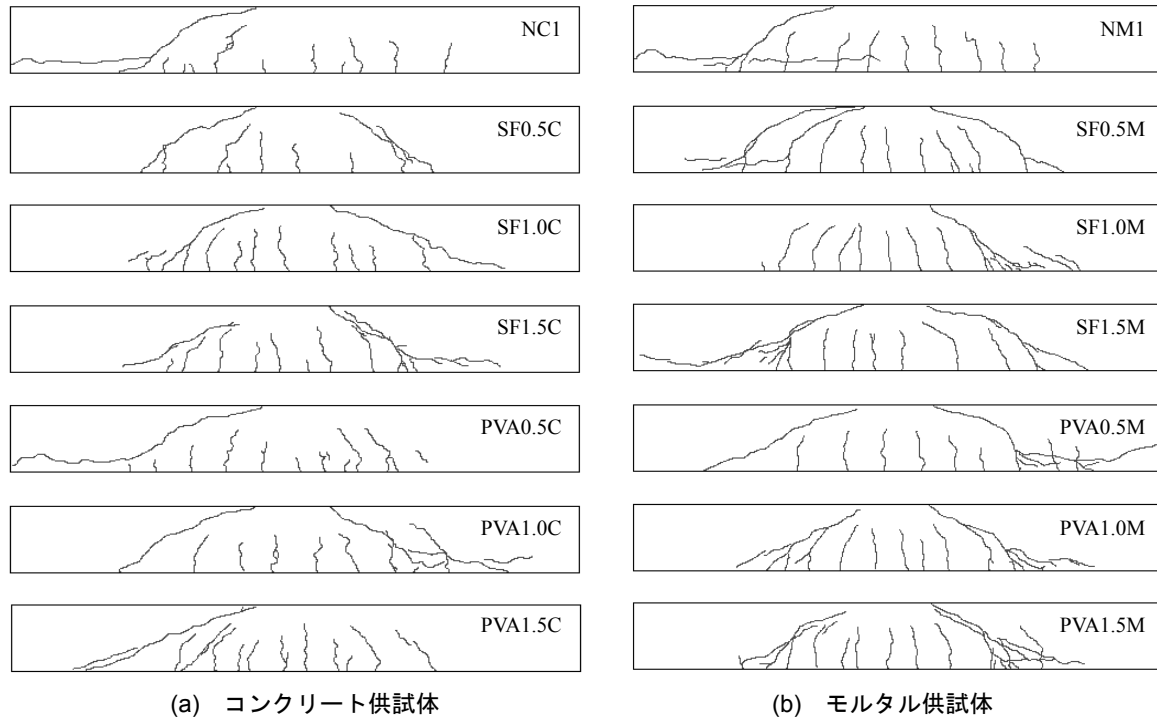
FRCC はり供試体の終局時のひび割れ発生状況
